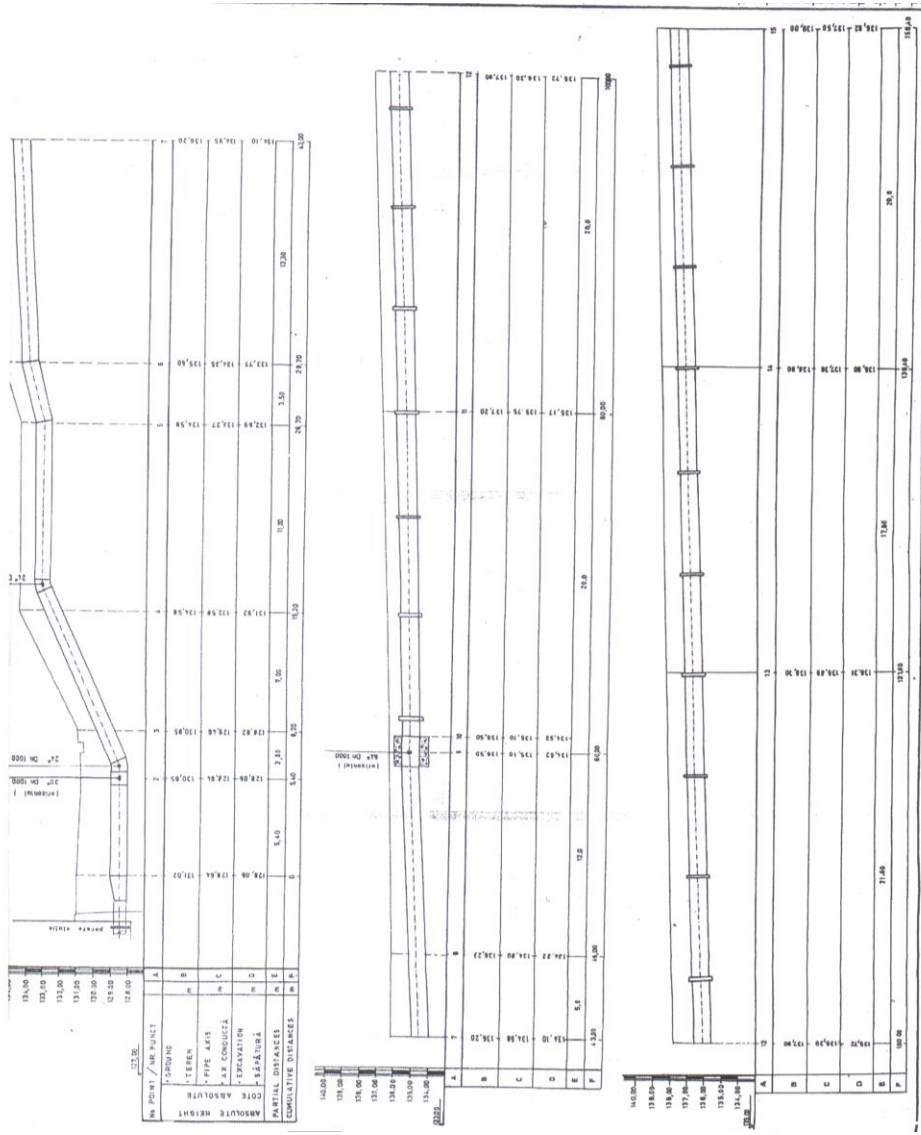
CONDUCTE DE REFULARE – PROFIL LIONGITUDINAL (FILA 2) (S.R.P.) [102]
